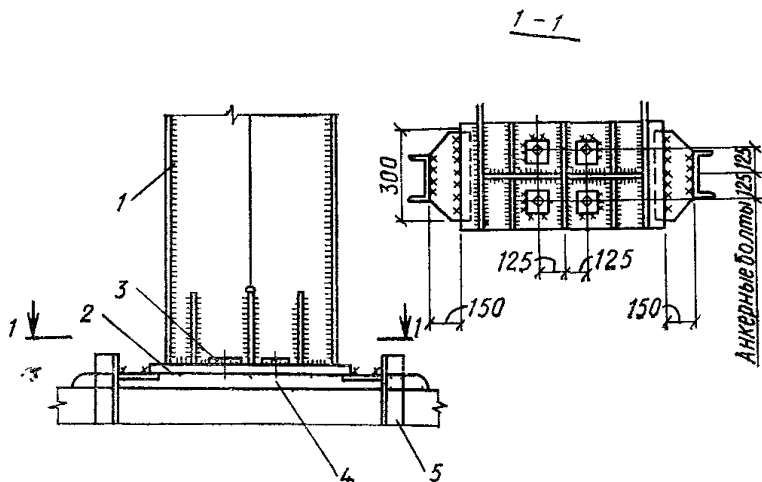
Опираение колонны на фундамент при отрывающем усилии до 70 тс
